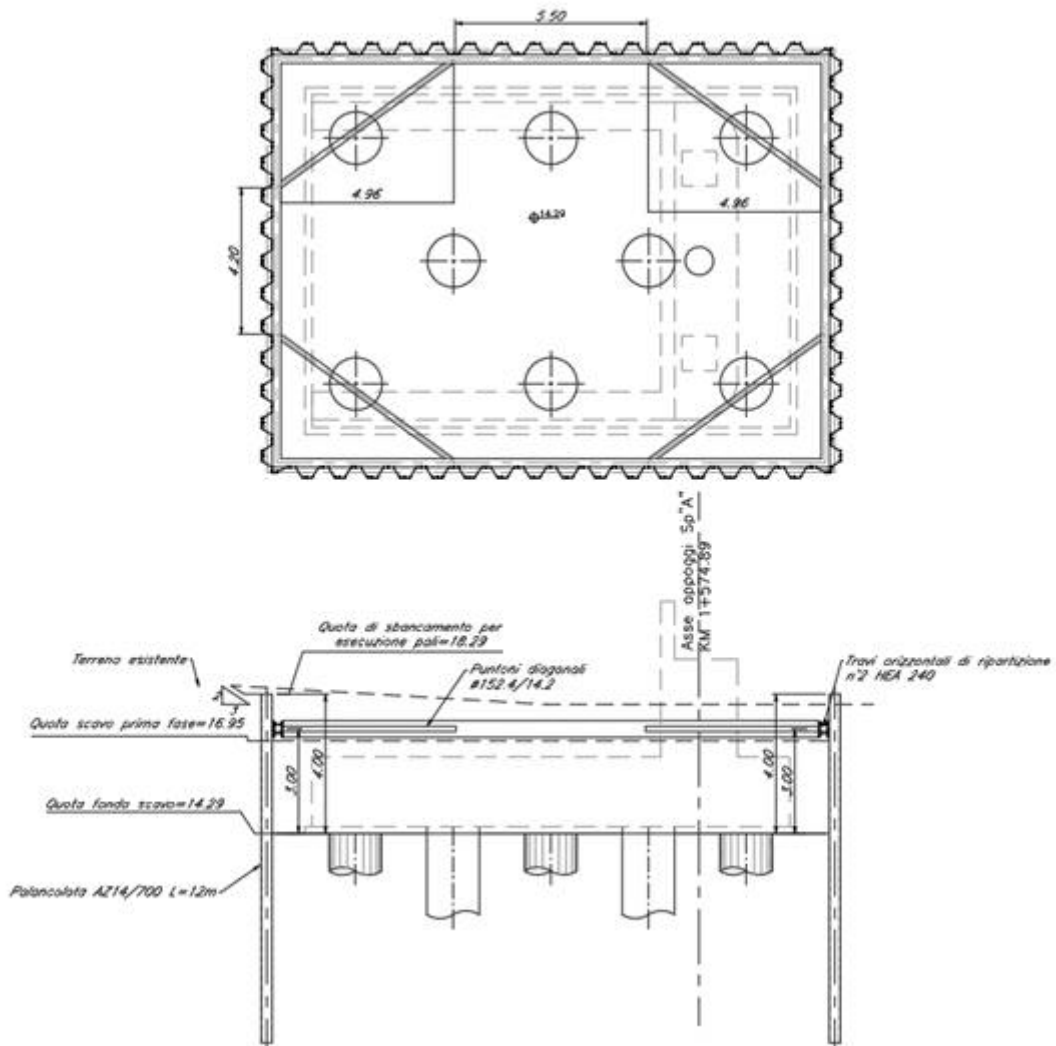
Pianta e Sezione Opere Provvisionali Spalla A
